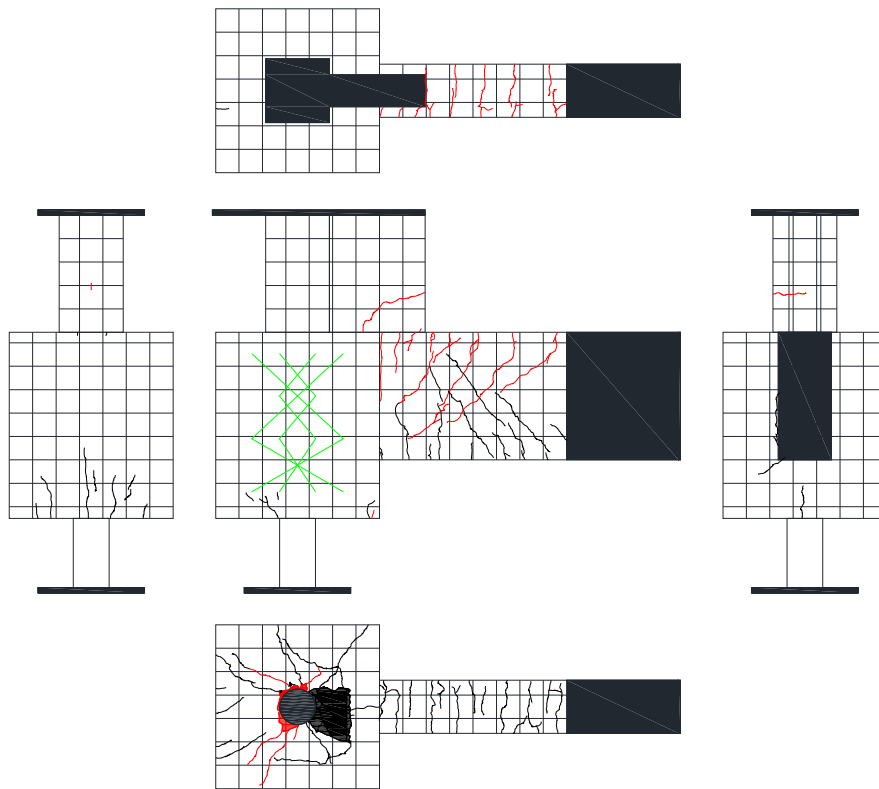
試験体 DR-1 ひび割れ状況 (6Cycle)
